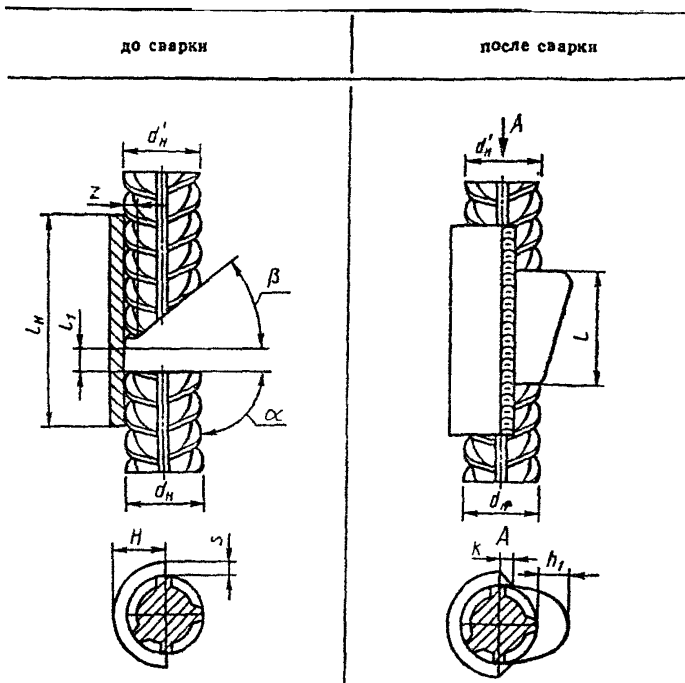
Конструкция вертикального стыкового комбинированного соединения, выполняемая на стальных скобах-накладках и формирующей инвентарной съемной детали (типа С27-Мф, С28-Мп и С29-Рс)
